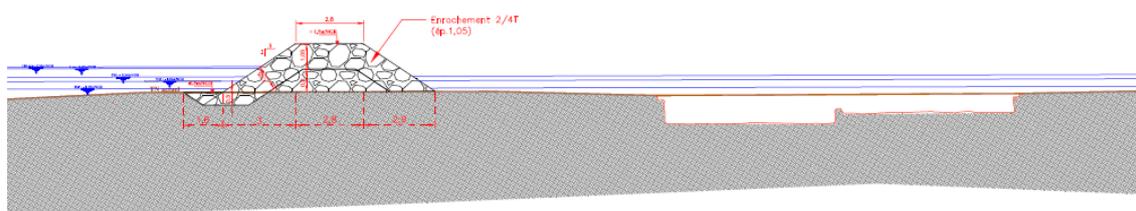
Vue en coupe de la fosse d'apprentissage de la baignade
